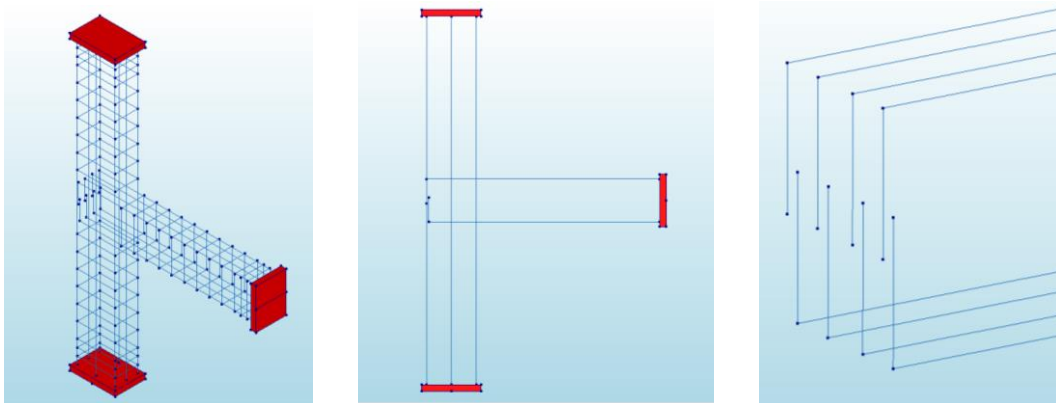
Elementos de refuerzo. Izq: Totalidad de refuerzo, Med: Refuerzo longitudinal, Der: Detalle ganchos.
